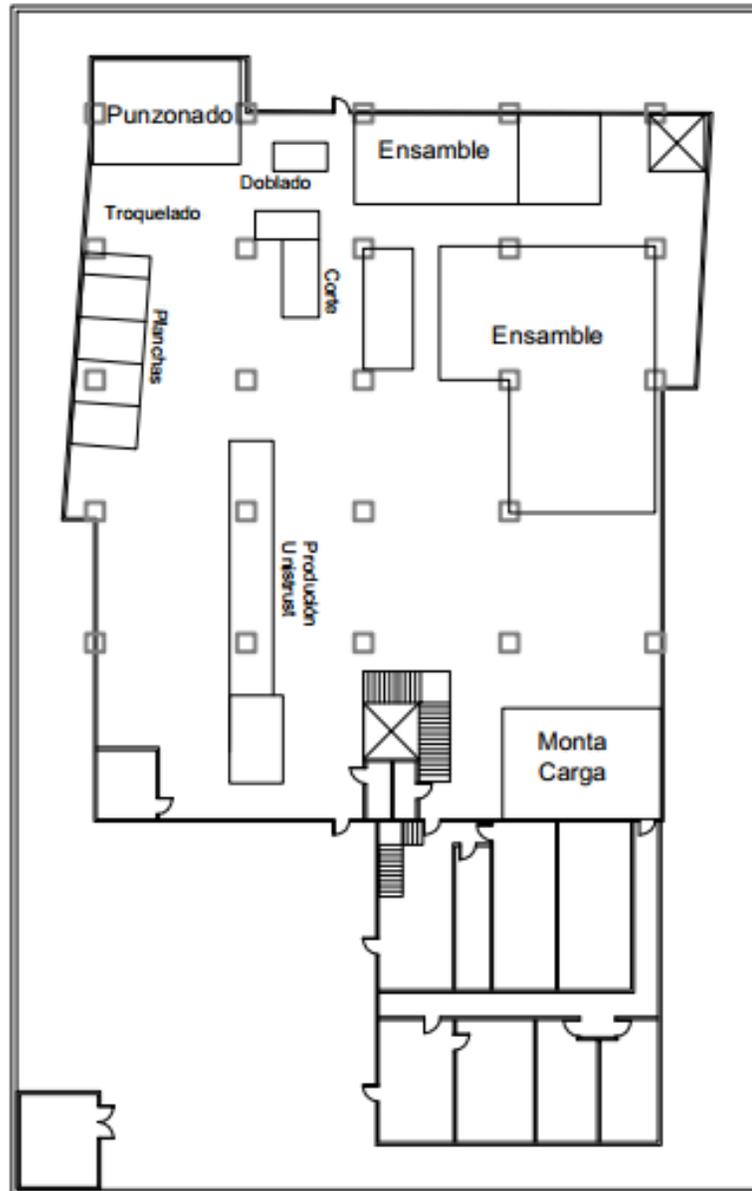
Plano arquitectónico de primer nivel de la empresa Industrial Electric. (Elaboración propia).
